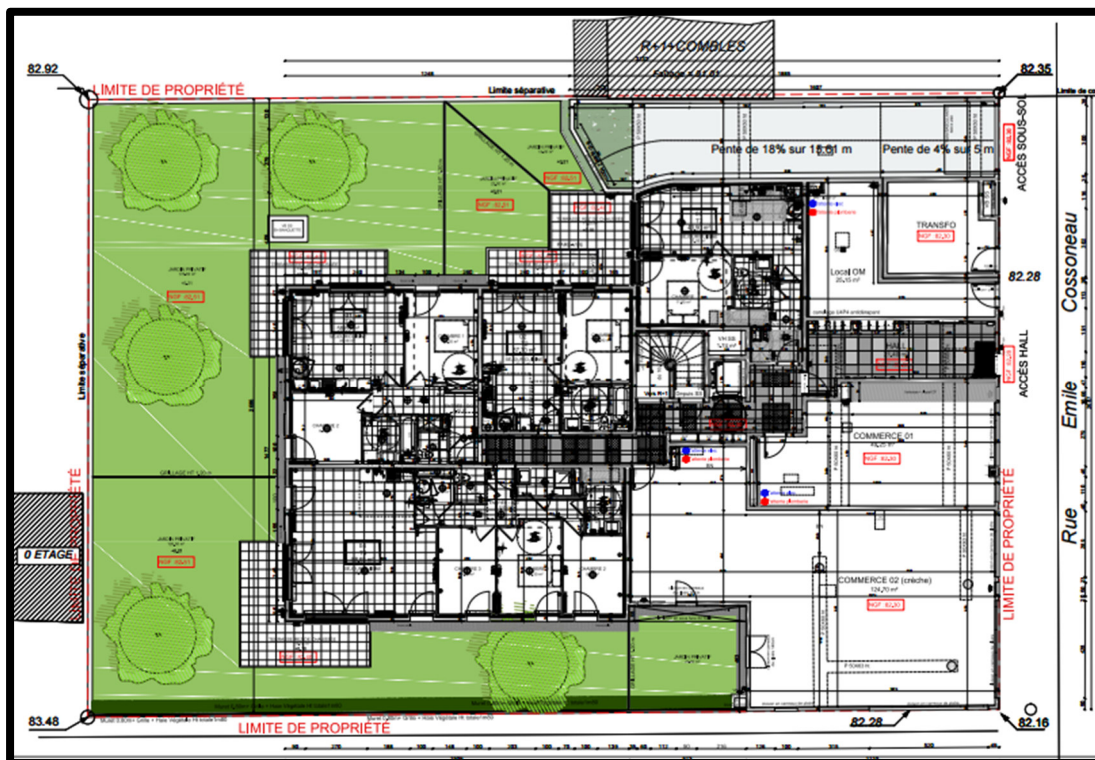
Planta RDC do edifício de estudo (fase projeto)
